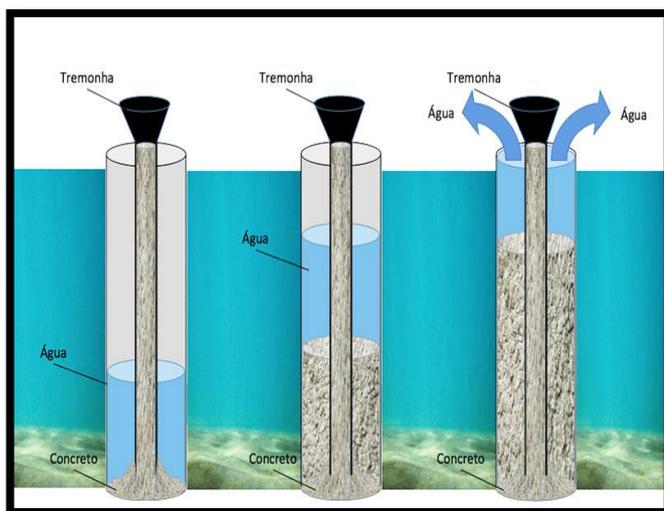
Lançamento do concreto com auxílio de tremonhas.
